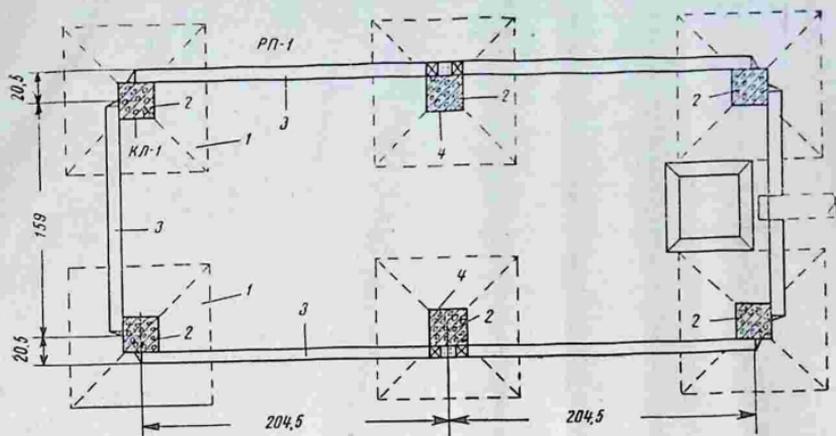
Жидкобсборник емкостью 25 м³ железобетонной сборной конструкции:
